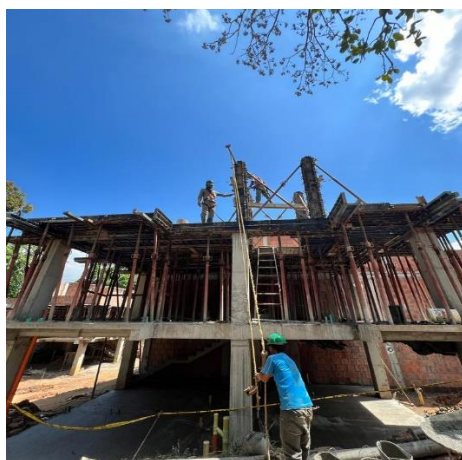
, Proceso de fundida columnas placa tanque casa 13B Manzana I, Fuente: Autoría propia.
